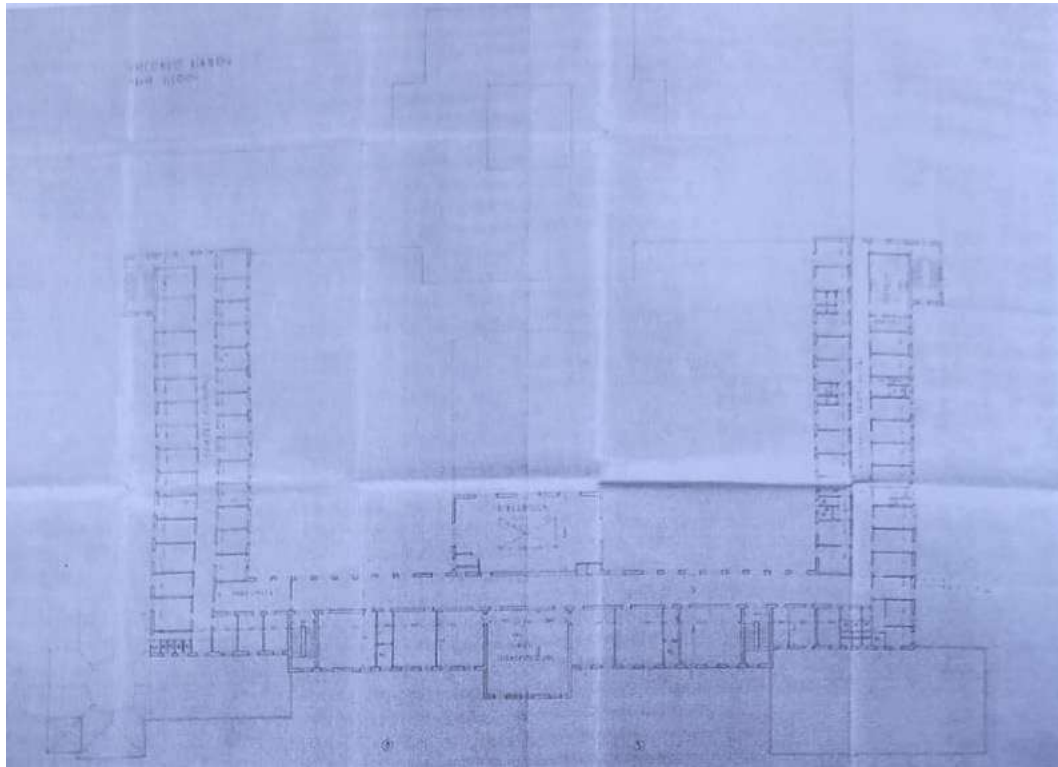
Planimetria piano primo da progetto originale dell' ing. Villa - ASSMT fald. 56.1, 56.2, 56.3 (Fonte: A. Sillo, L'altro castello di Rivoli, Impremix Edizioni, 2024)
